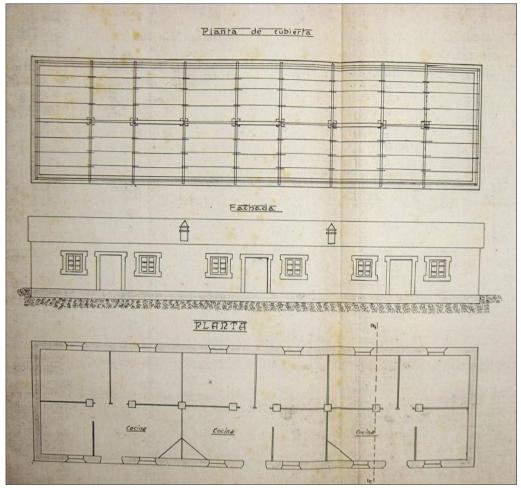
Plano del proyecto de casas para tres viviendas de Tahivilla. 1935.
